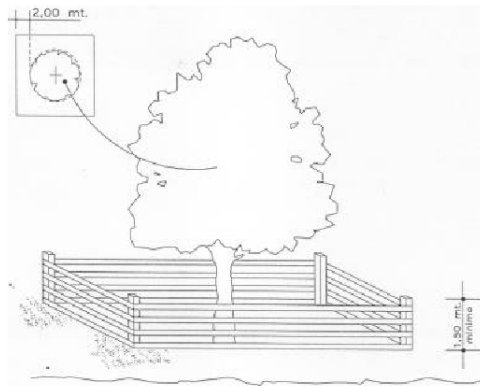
Protezione dell'albero attraverso la delimitazione dell'area minima di rispetto in aree parco
